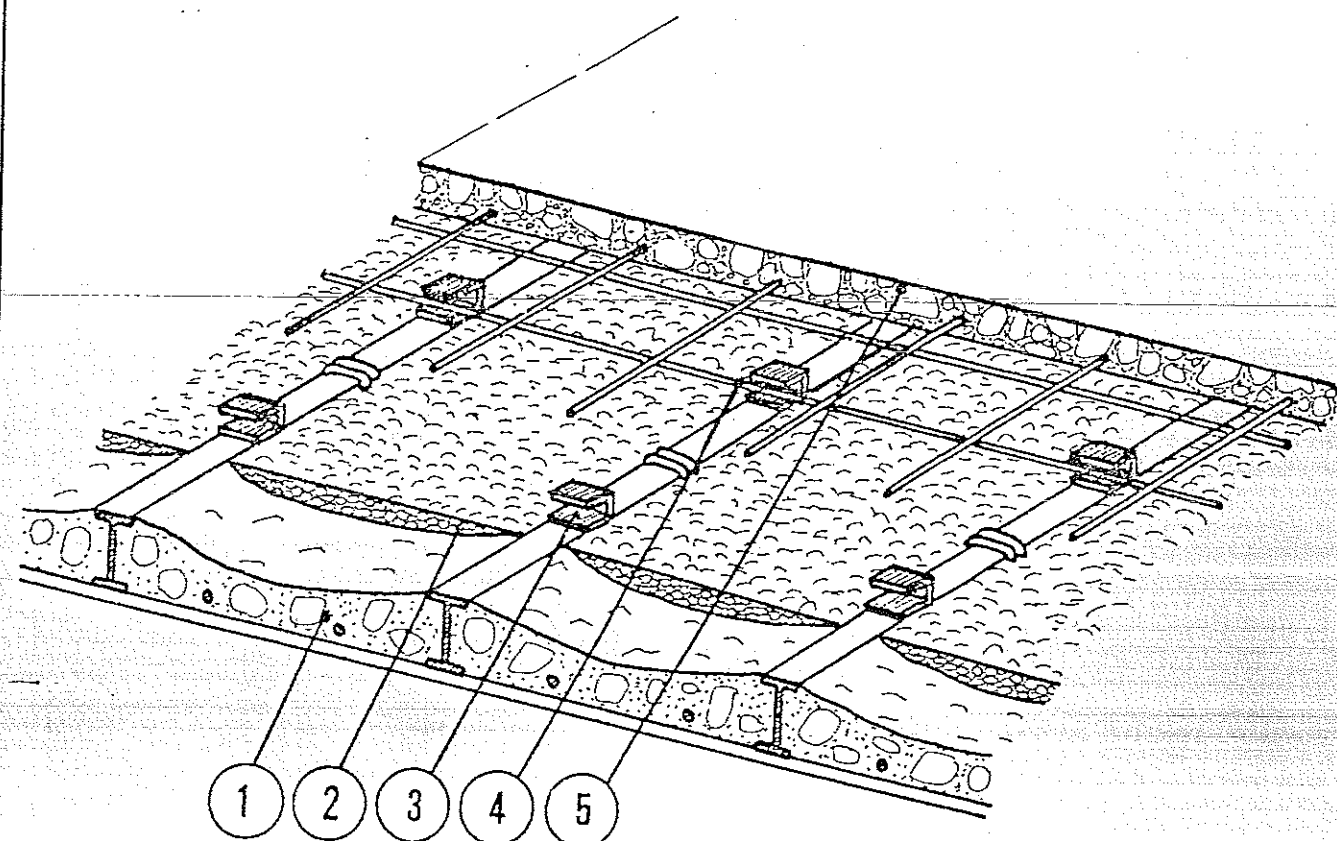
Renforcement d'un plancher métallique : plancher collaborant
